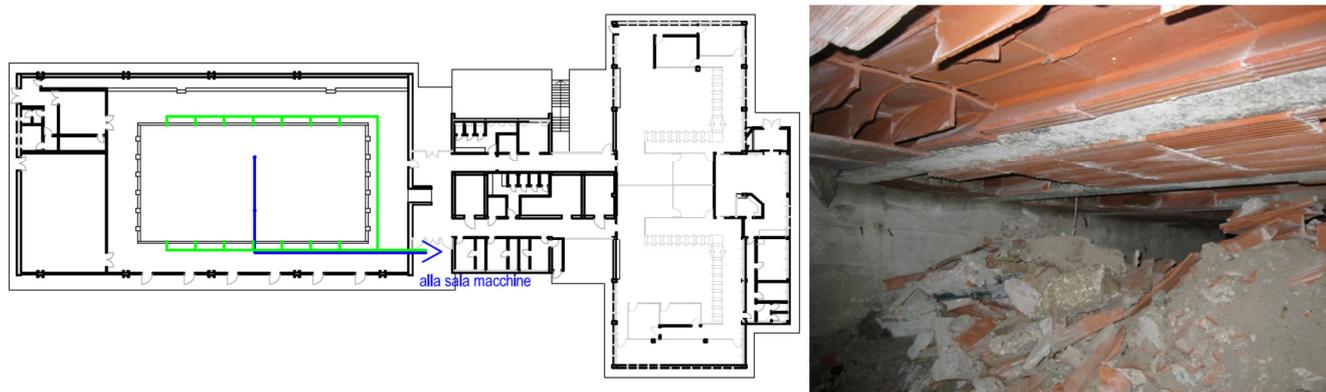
(pianta scarichi e vista dalla botola di ispezione)
